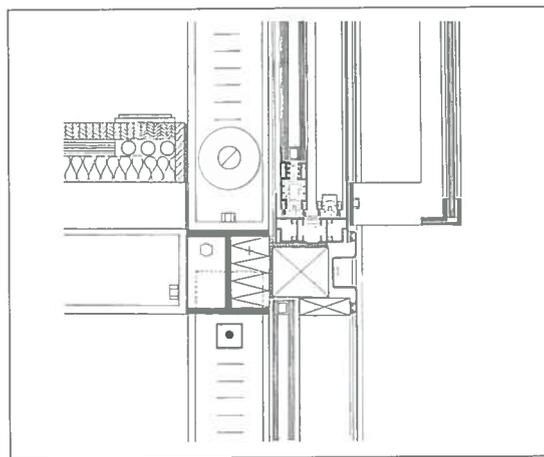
Sezione verticale in dettaglio dell'involucro in corrispondenza dell'incontro con il solaio.
